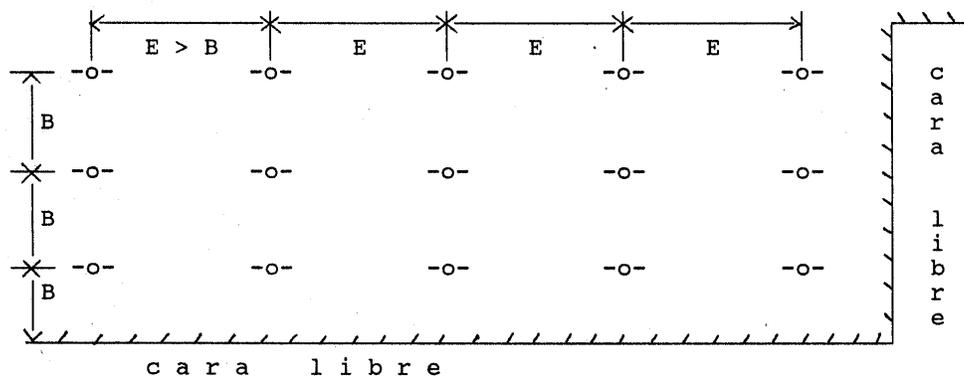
, PLANTILLA RECTANGULAR $B < E$ (vista en planta).
